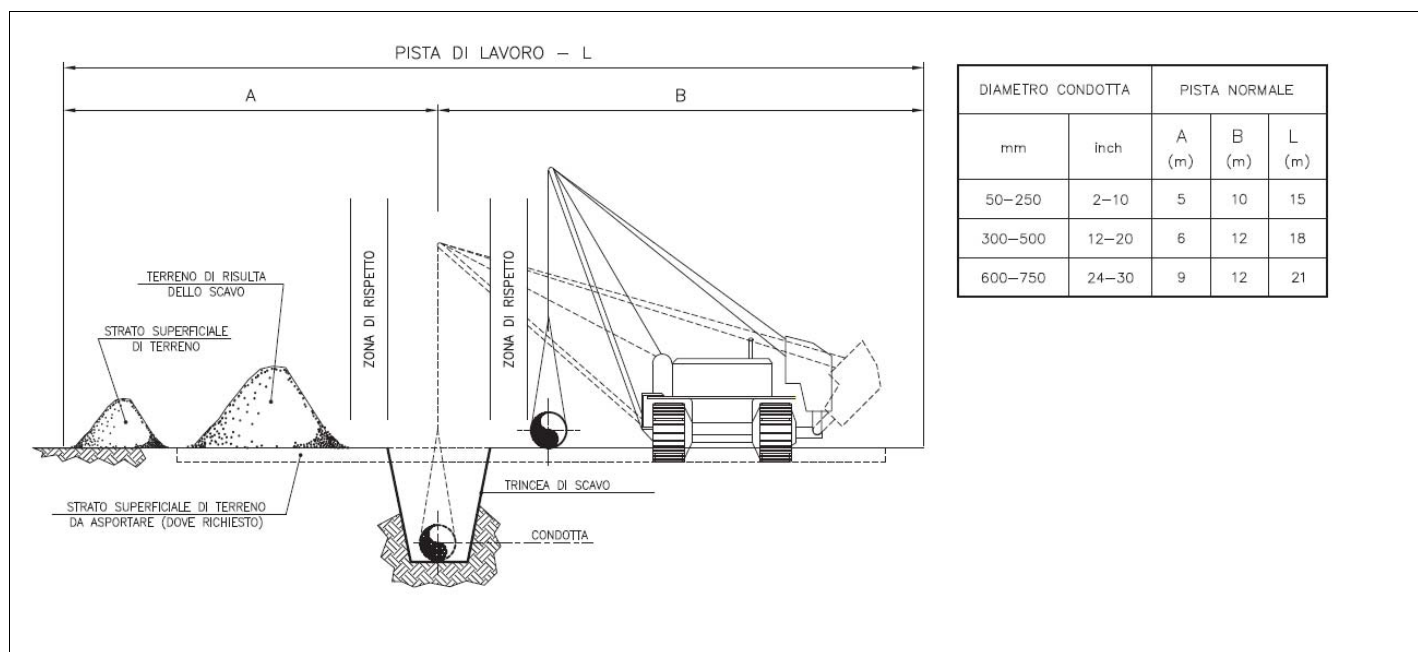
Sezione tipica della pista di lavoro “normale” (STD 00401A⁸)
